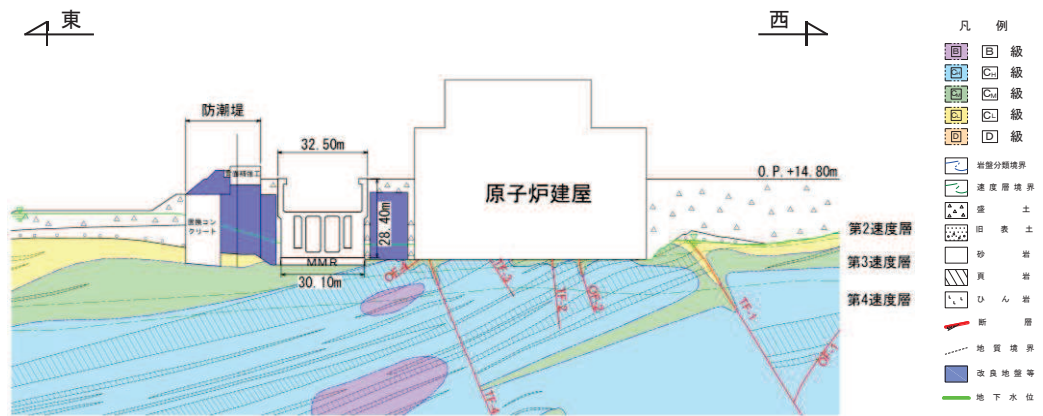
海水ポンプ室 地震時荷重算出用地質断面図 (B-B 断面, 東西 (補機ポンプエリア))
